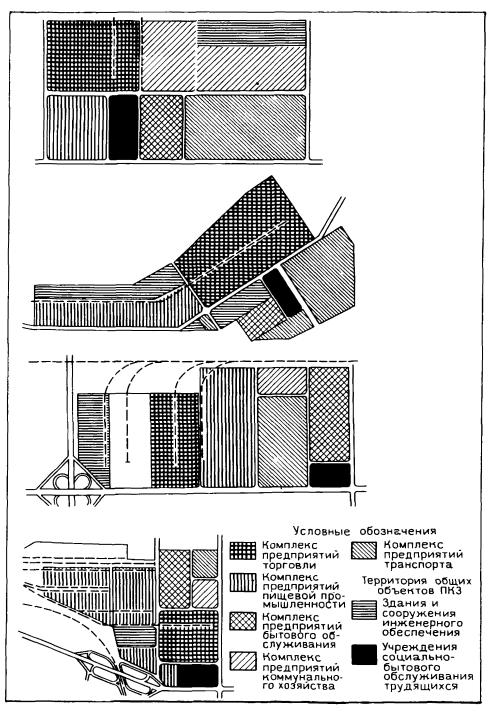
Формирование планировочной структуры промышленно-коммунальных зон
